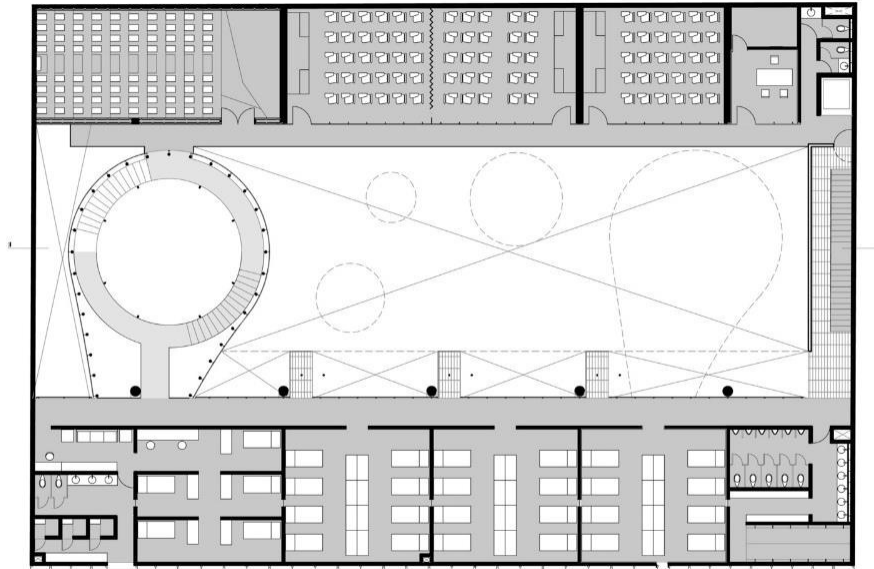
Estación de Bomberos Ave Fénix. Plano de tercera planta
